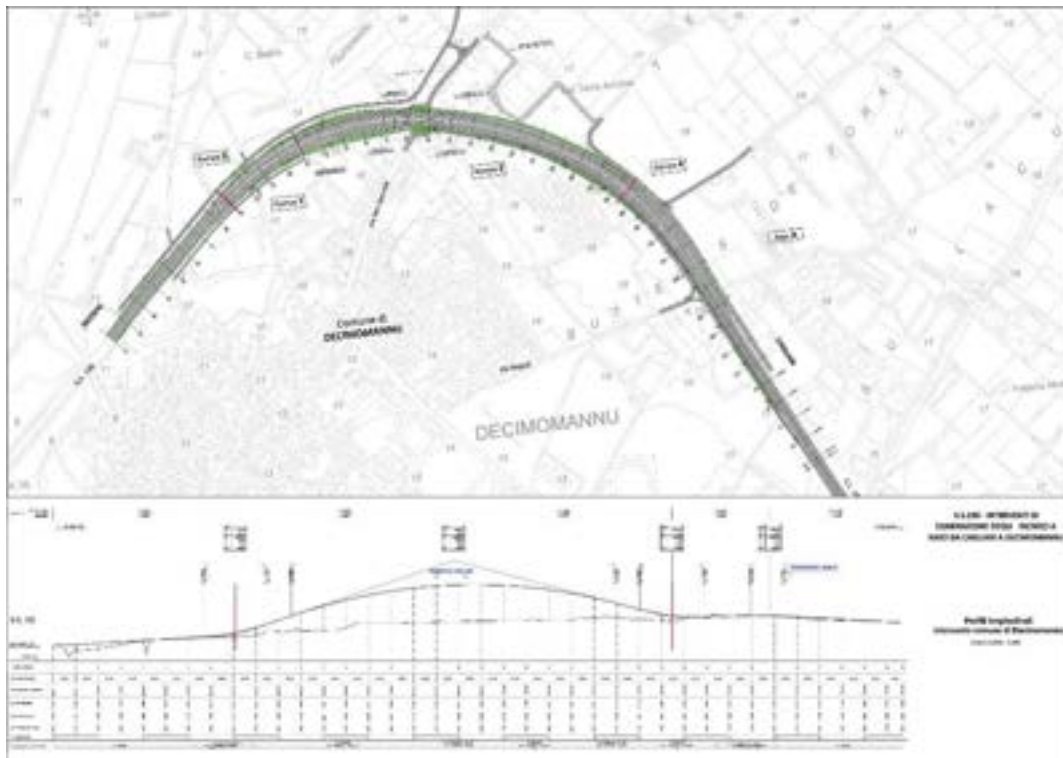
Decimomannu, planimetria su CTR e profilo longitudinale asse principale (Anas - Schemi 2019).
